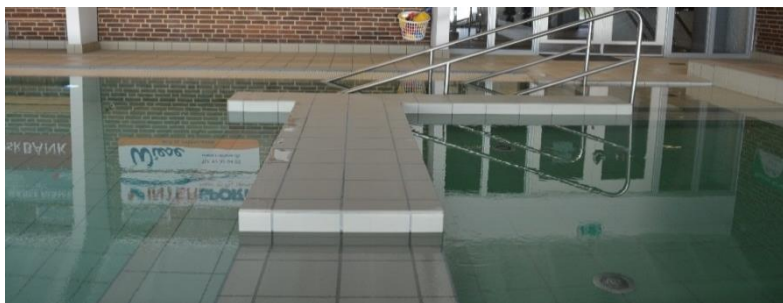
Soppebassin med overgang til resten af det lave bassin i Ringkøbing Svømmehal.
